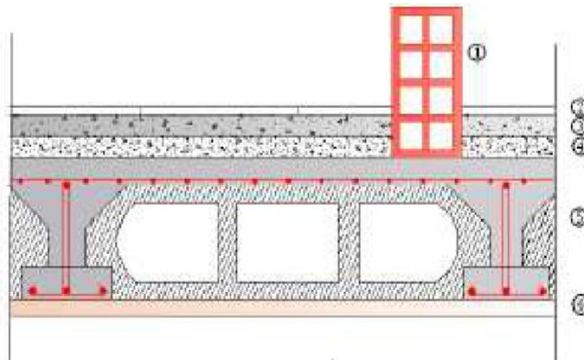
Coupe verticale du plancher de l'étage courant.
